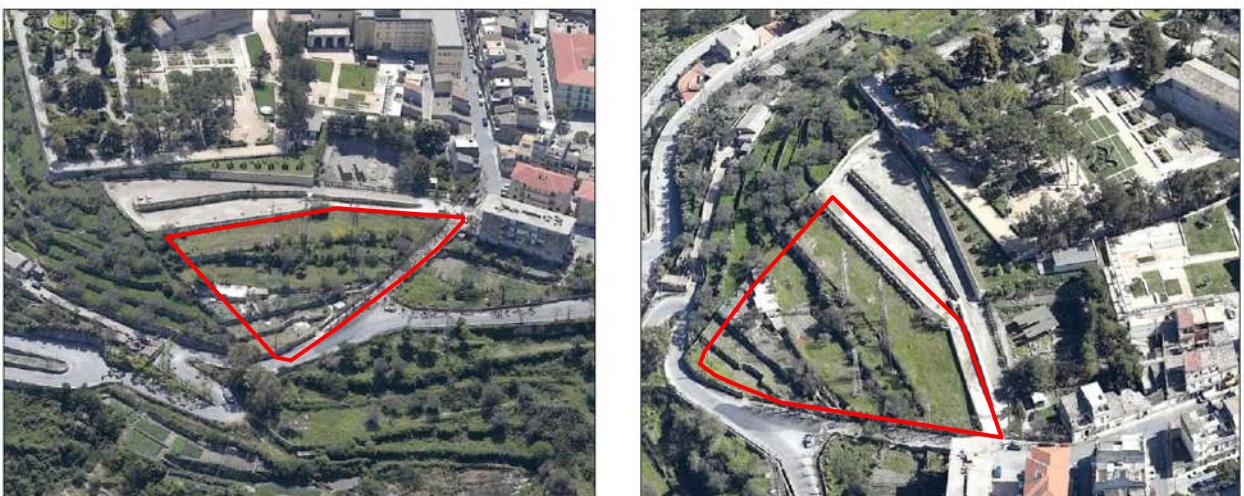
Viste dall'alto dell'area oggetto d'intervento
